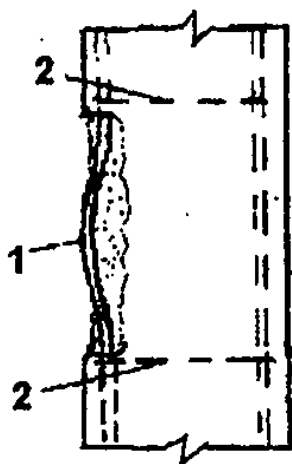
Схема руйнування в стиснутій зоні бетону при втраті стійкості стрижнями стиснутої арматури: 1 – поздовжня стиснута арматура; 2 - поперечна арматура
